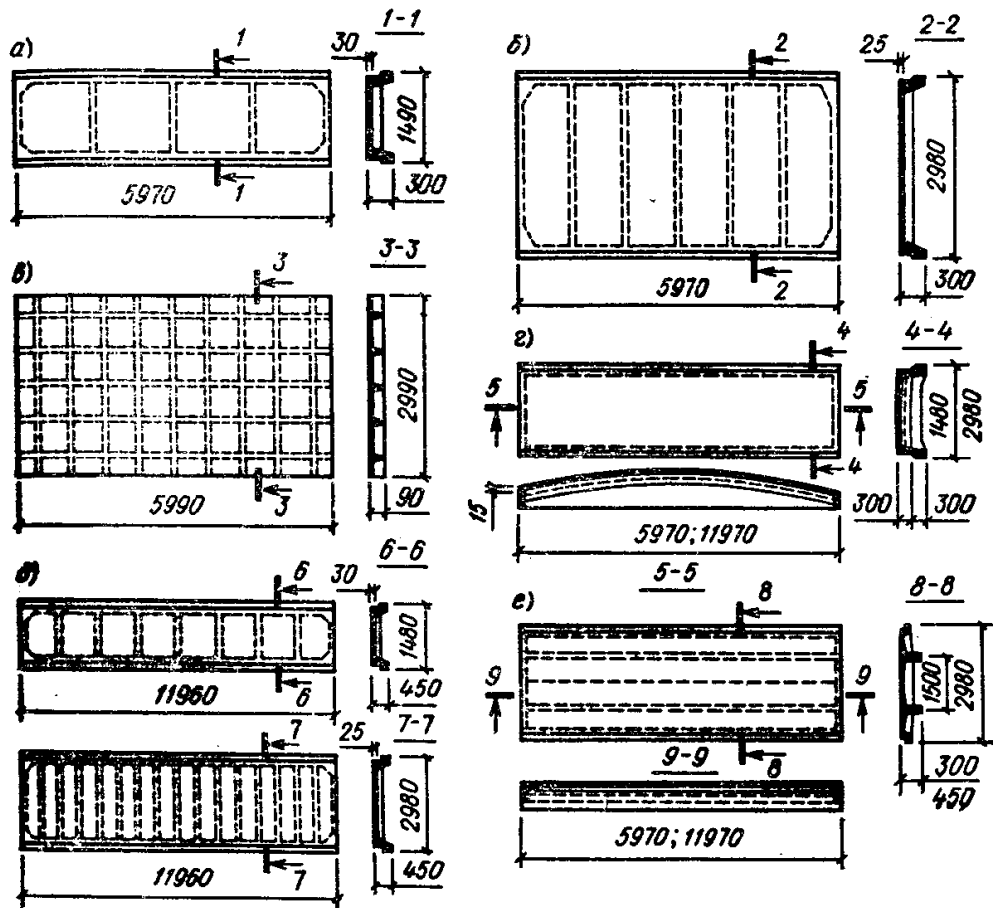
Крупноразмерные железобетонные панели покрытий:
